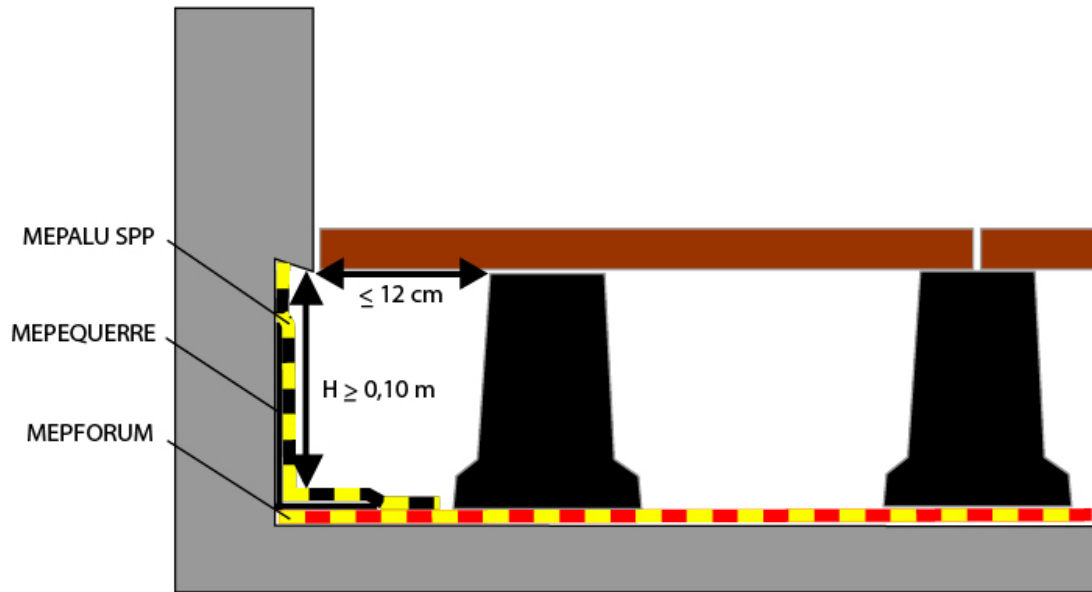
Exemple avec tête de relevé sous le niveau fini de la protection directe par dalles sur plots
